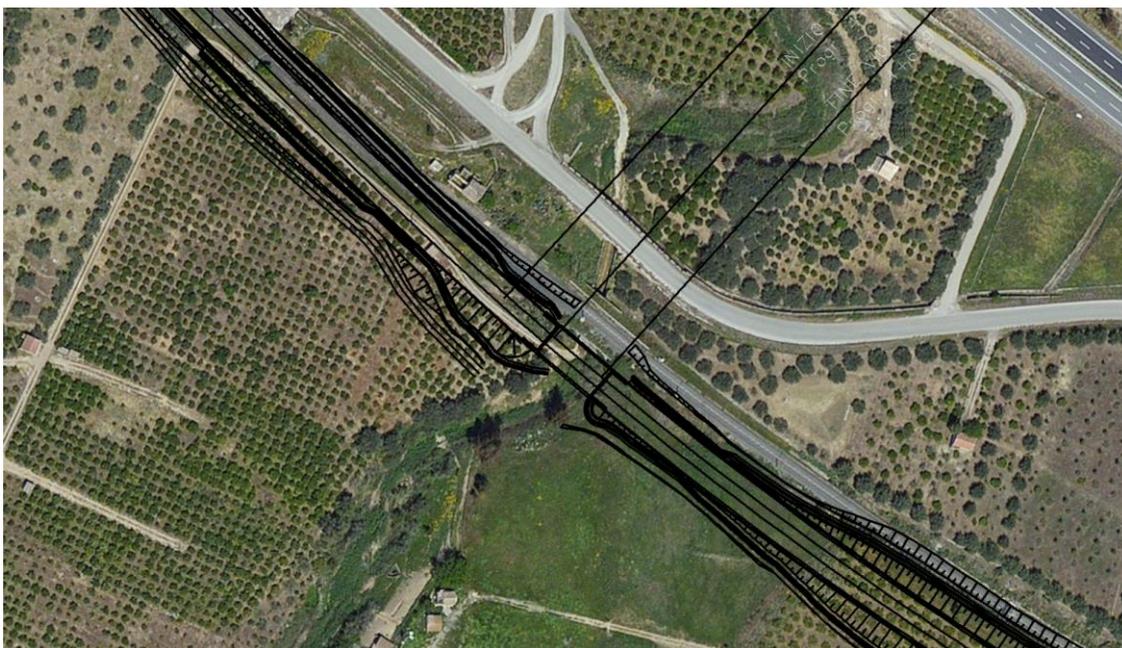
Attraversamento ferroviario del Vallone la Rosa. Planimetria progetto su ortofoto
